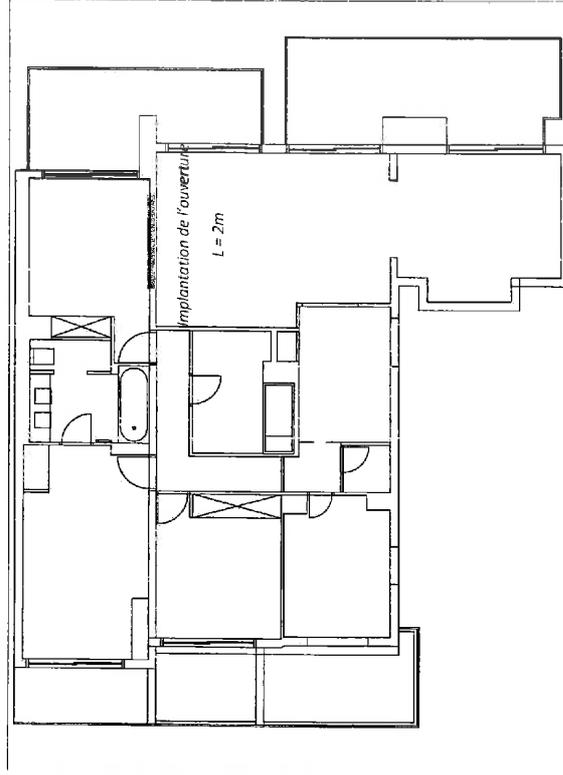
Plan existant de l'appartement au 3^e étage / fournis par la maîtrise d'ouvrage
